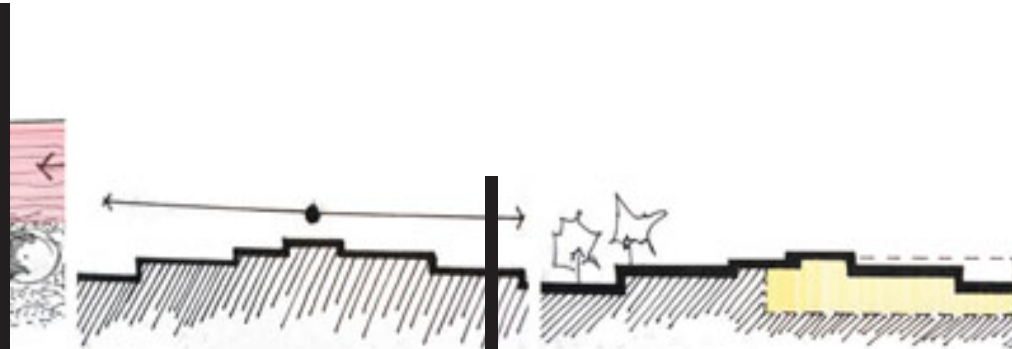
Secciones longitudinales y transversales sitio A. / Fuente: propia
